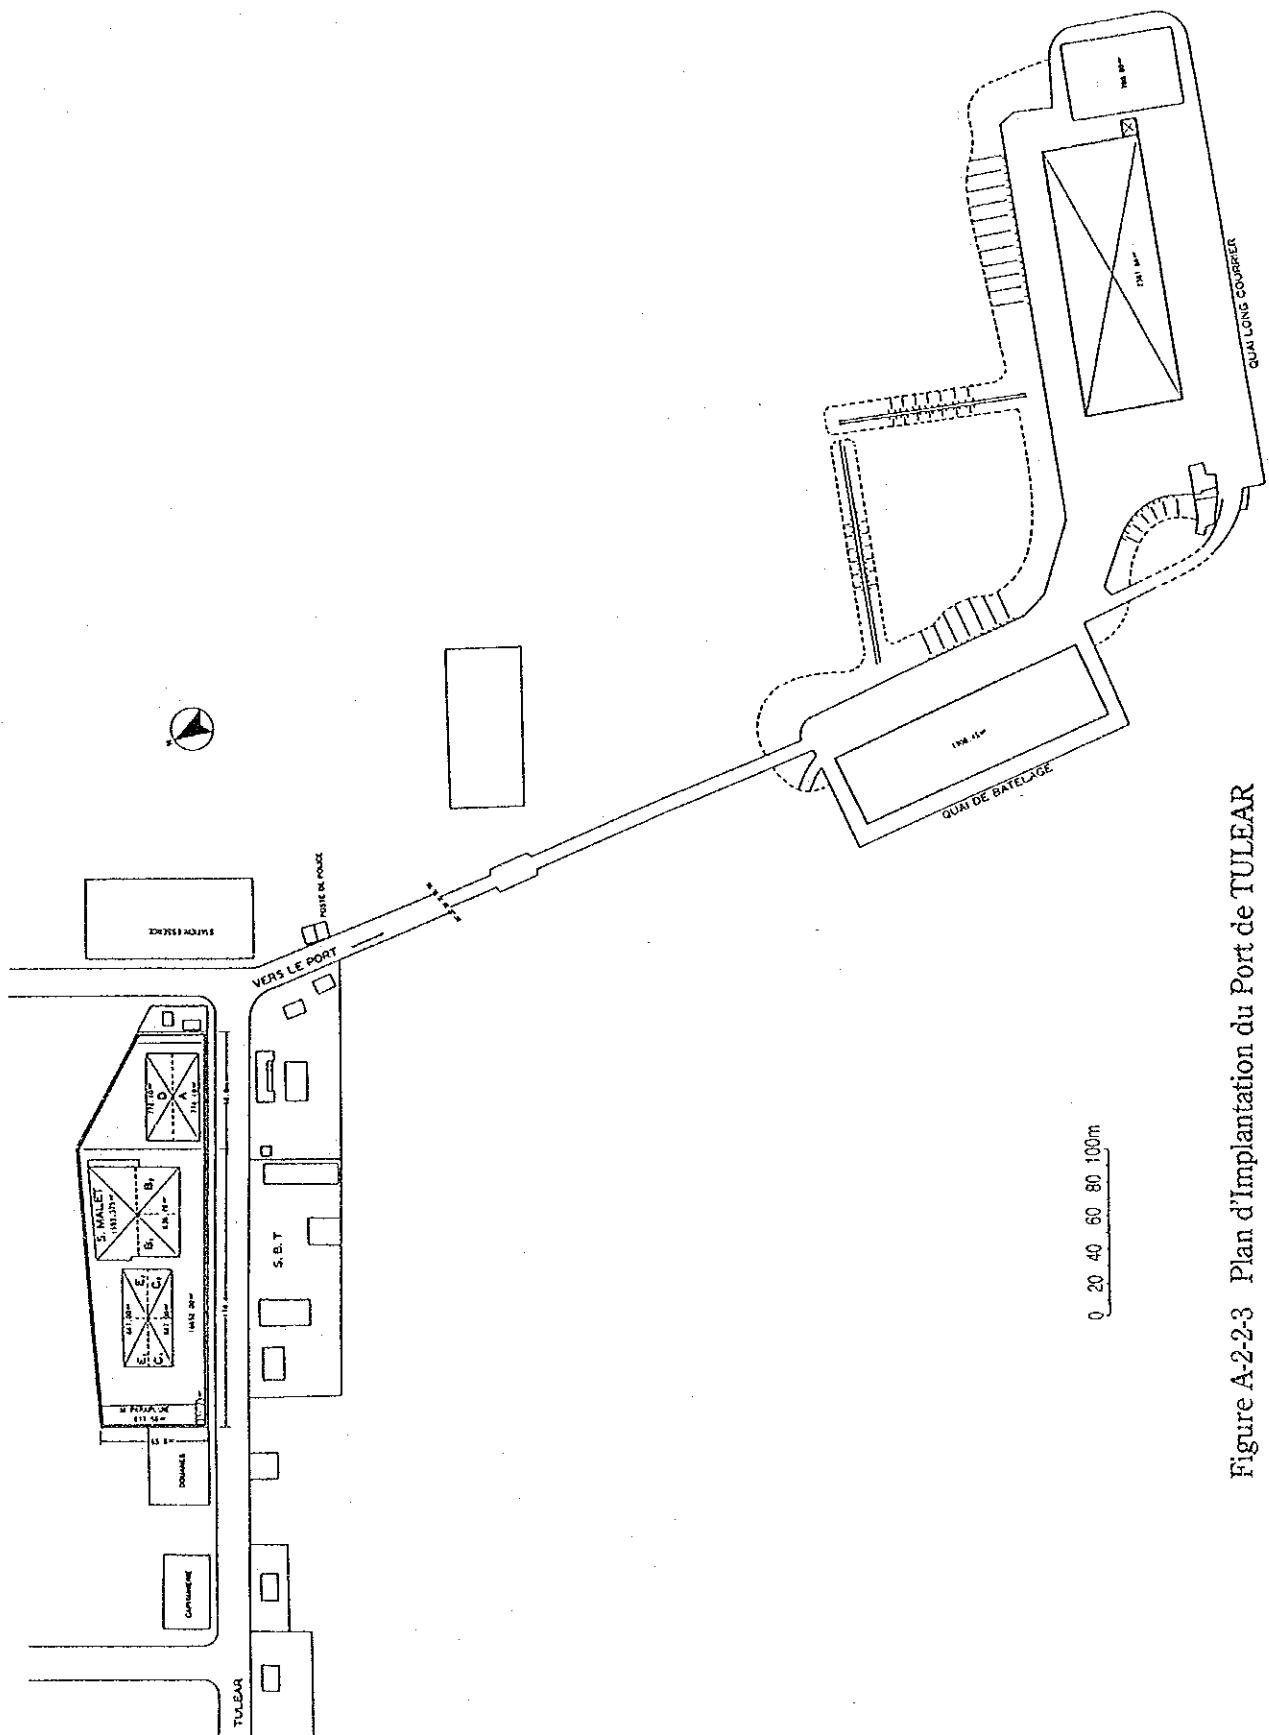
Plan d'implantation du Port de TULEAR
